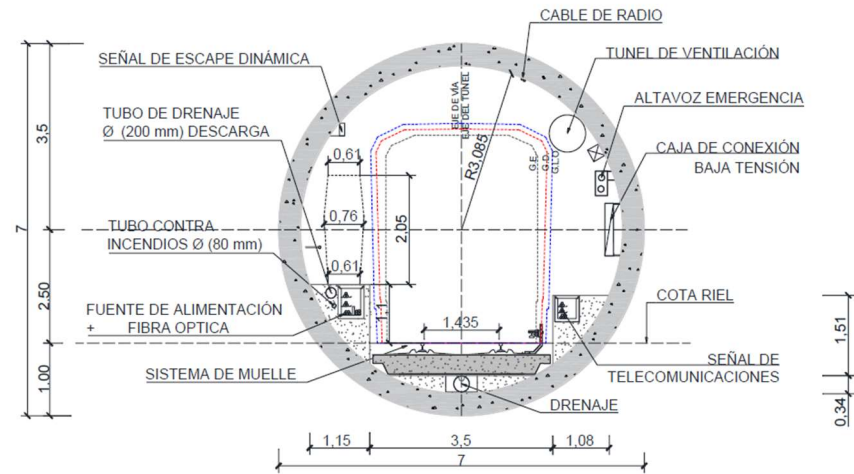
Sección Bitúnel- Egist Steer( 2021)
